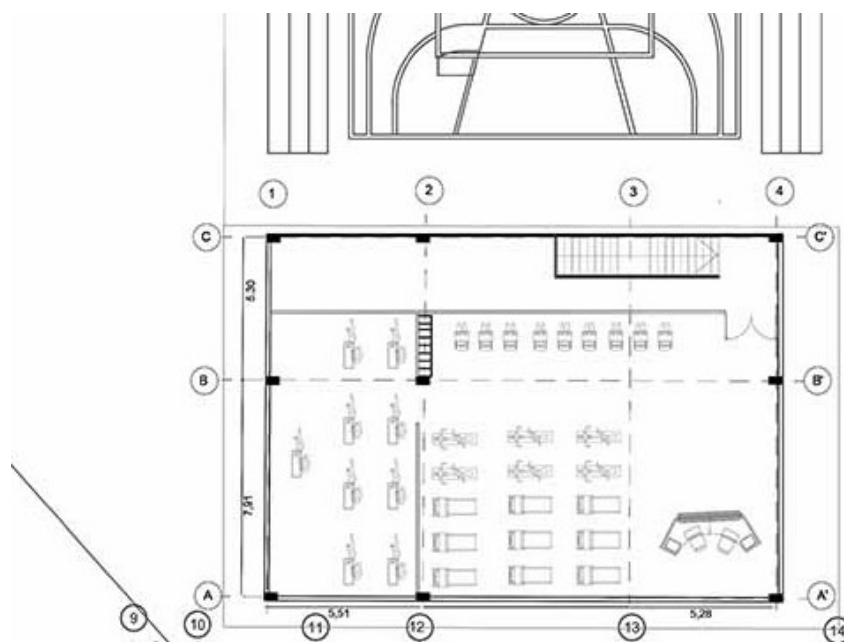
Planta 2do piso bloque de Bienestar. Fuente: Elaboración propia.
